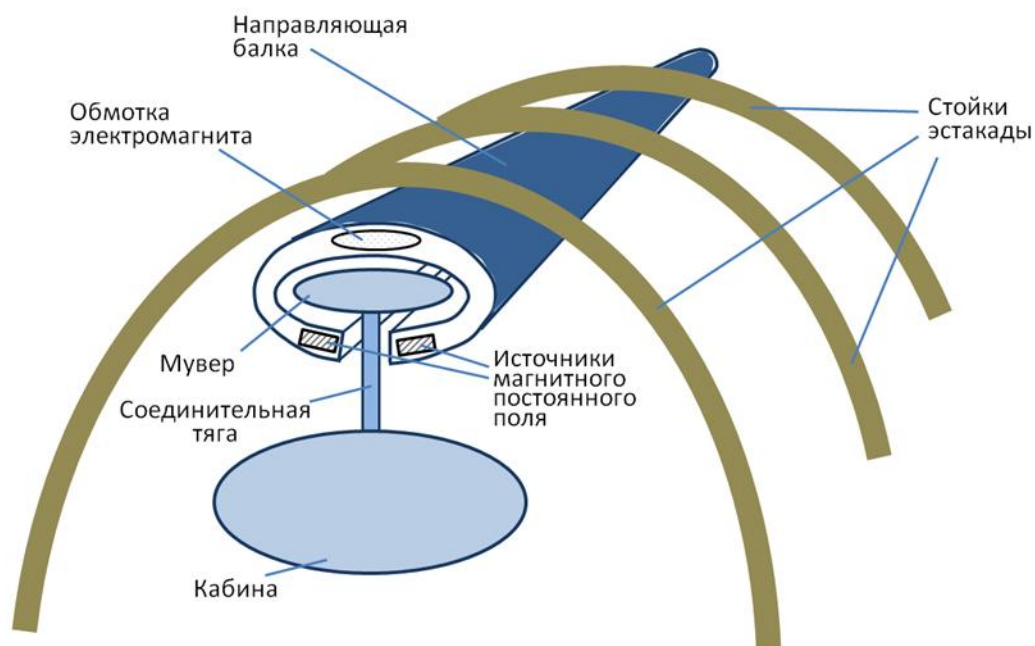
Объемный вид эстакады арочного типа с нижним расположением кабины
